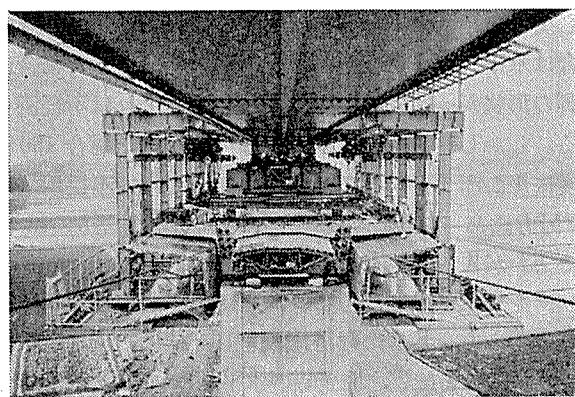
ゲリューストワーゲン移動中（底型枠が左右に開かれ、内枠も同時に引き出されている）
